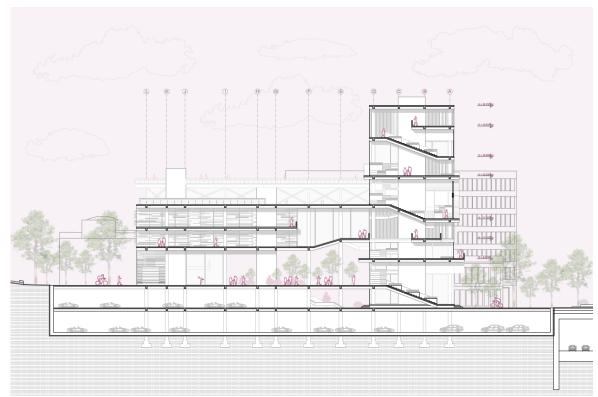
Corte Longitudinal Norte. Elaboración propia.
